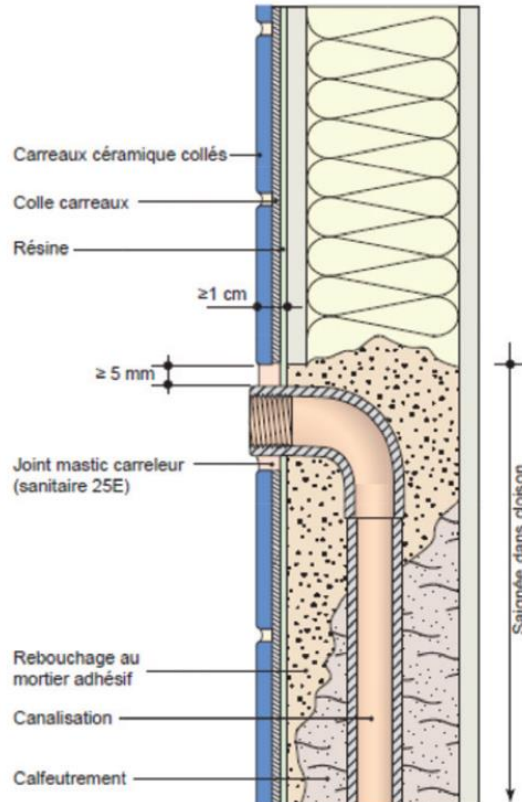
Traitement d'une canalisation encastrée (sans fourreau) en paroi verticale ; exemple d'une cloison en plaques de parement en plâtre.
